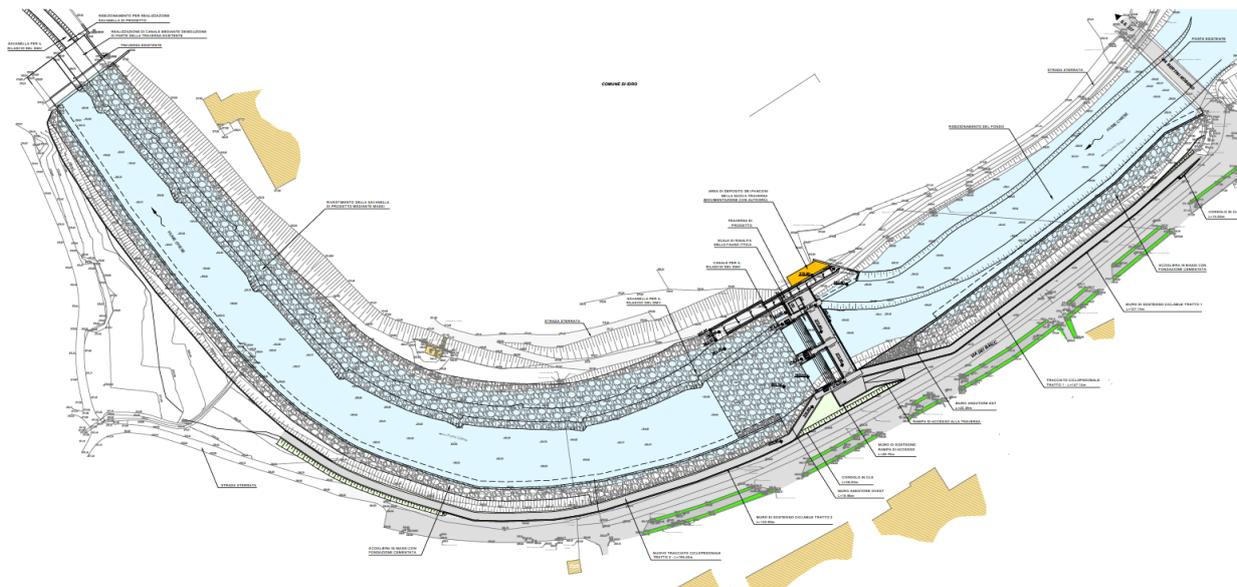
Planimetria nuova traversa e sistemazione alveo Fiume Chiese (elaborato: PE-NTR-OSD-GE-003-PL-A)
